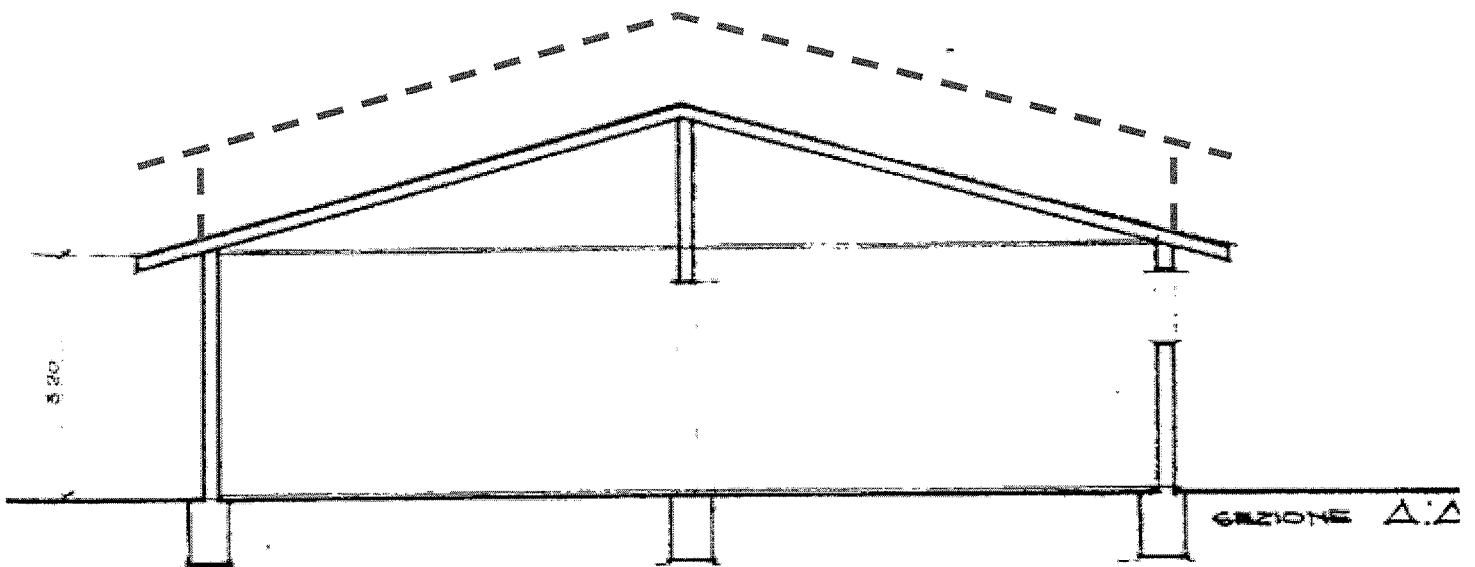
sezione STATO AUTORIZZATO AUT. ED. 43/1974
